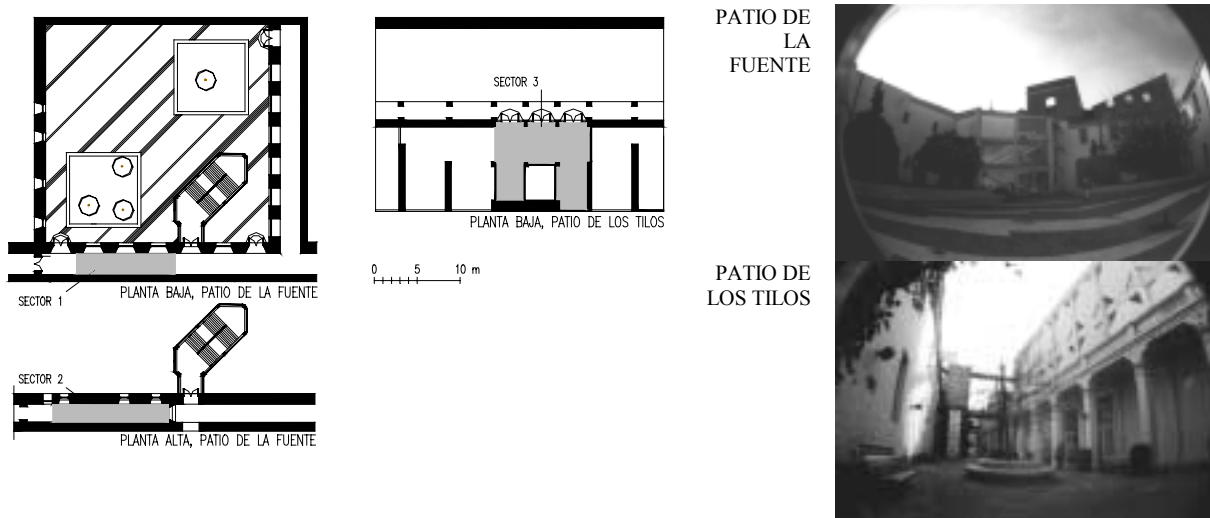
Planta e imágenes del Centro Cultural Recoleta.
